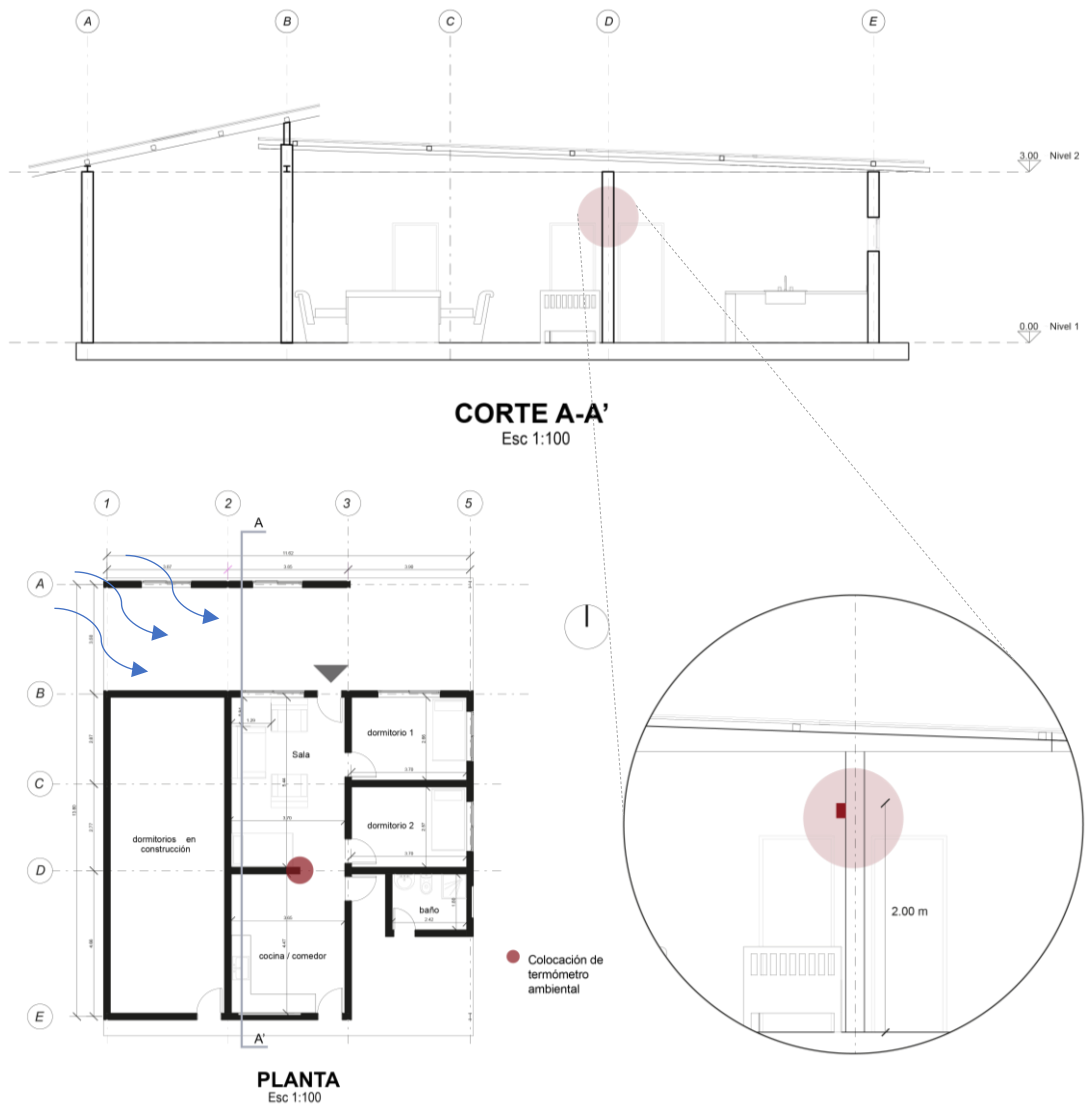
Punto de colocación de instrumento de medición mostrada en planta arquitectónica y sección de tipología de vivienda 1
